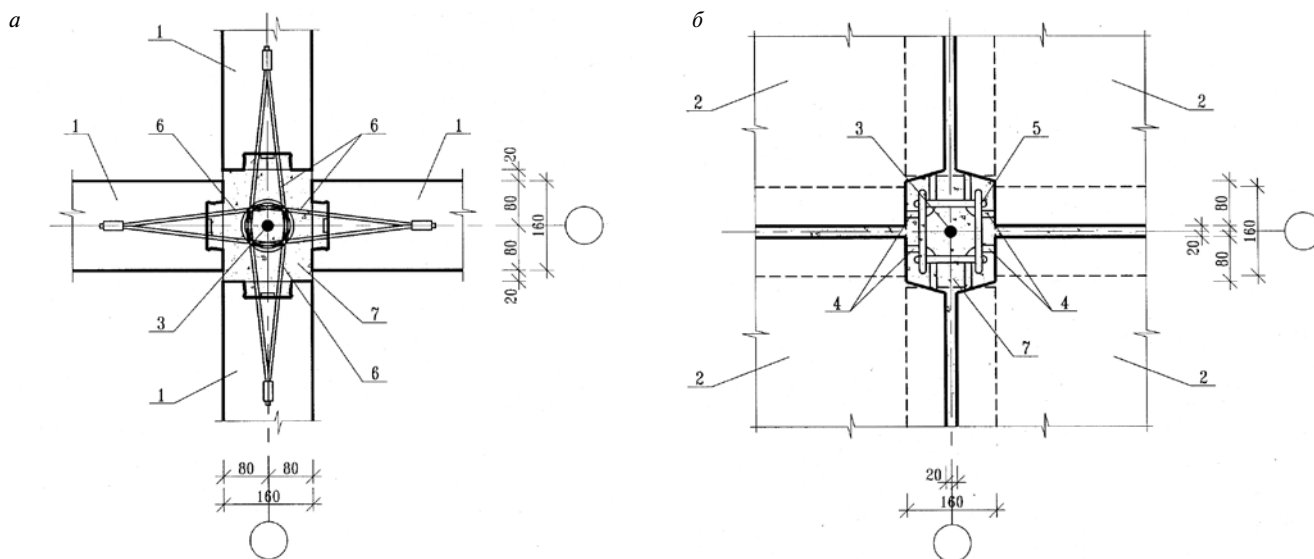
Монтажный узел внутренних панелей с тросовыми петлями: а – в уровне стен; б – в уровне перекрытий; 1 – внутренняя стеновая панель; 2 – плоская плита перекрытия; 3 – продольная арматура $\varnothing 16-20$ А400 (по расчету); 4 – арматурный выпуск $\varnothing 12$ А240 из плиты перекрытия; 5 – каркас КР-1 (надеть на продольную арматуру и привязать к арматурным выпускам плиты перекрытия); 6 – петли из стального каната (фирм HALFEN, PHILIPP, PEIKKO и др.); 7 – мелкозернистый бетон кл. В25–В40
